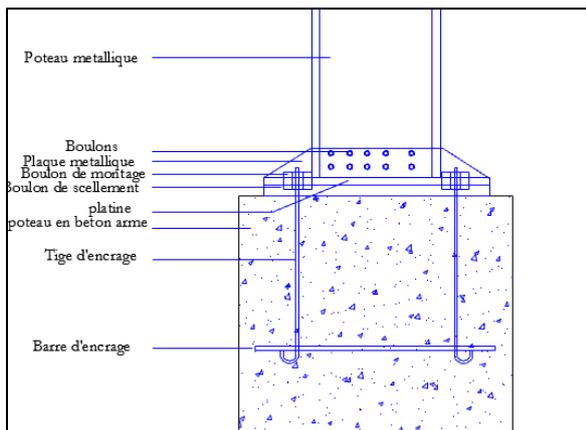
Liaison Poteau métallique et poteau en béton
